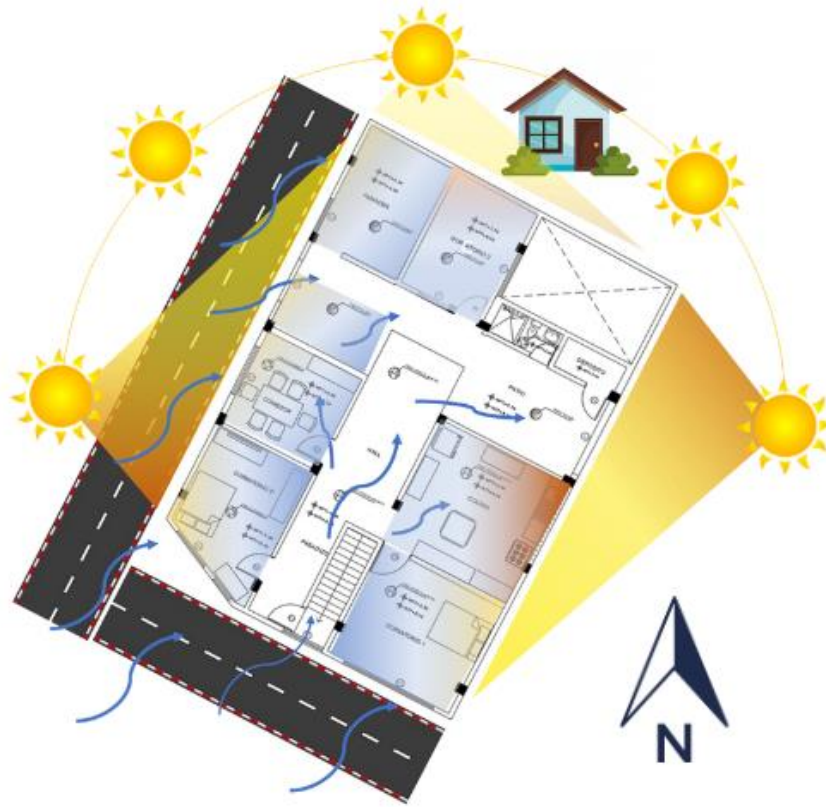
Plano de la vivienda FA – Nivel 3er piso
